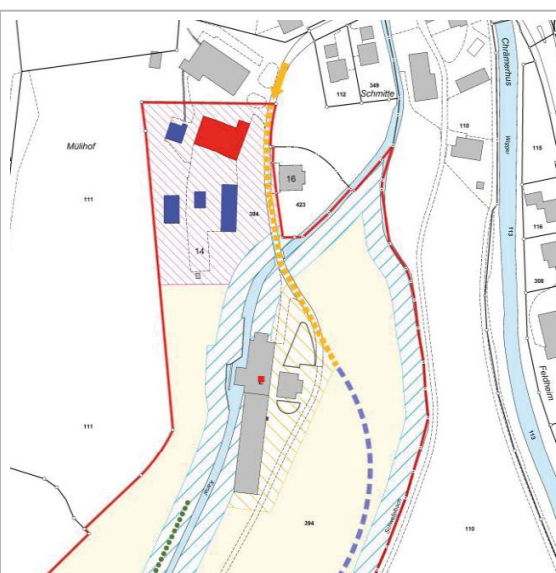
Bebauungsplan neu, Erschliessung Neue Steinermühle via Dorf.
